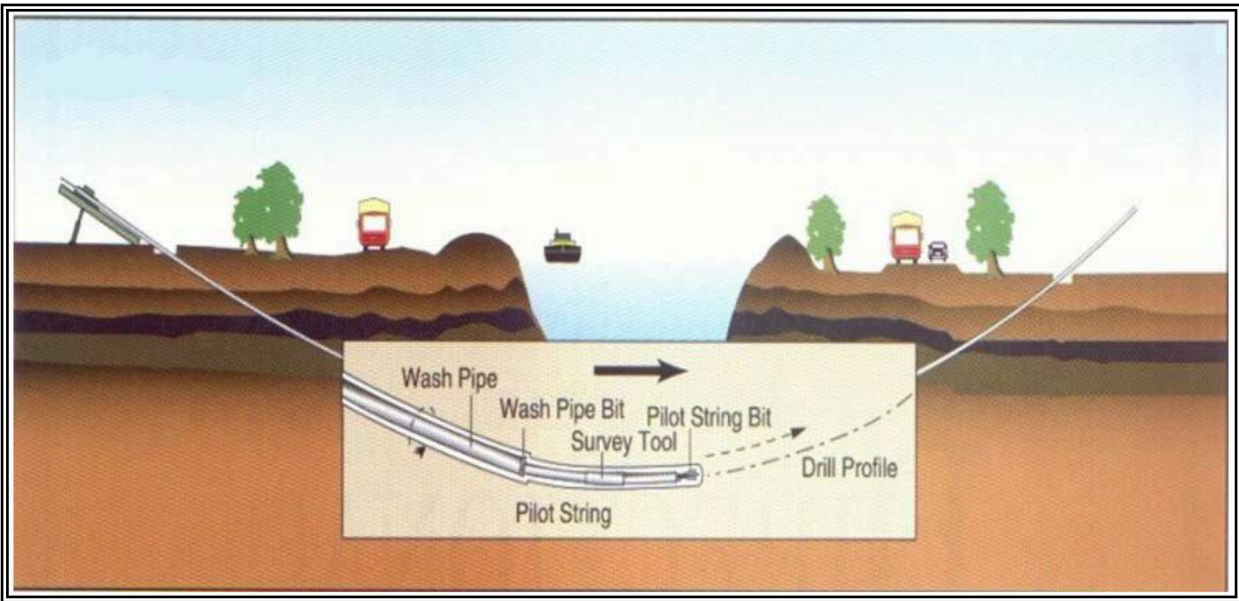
Técnica de perforación direccional empleada para colocar las tuberías de manera horizontal.
